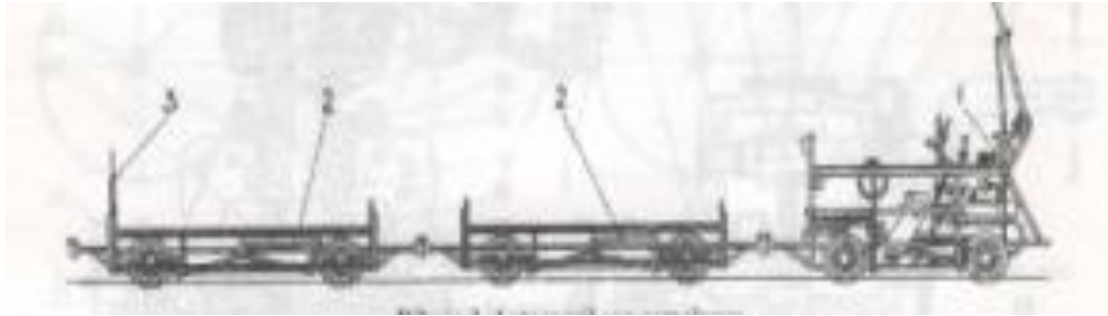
Autocarril TD5M desmontable con dos remolques (4)
